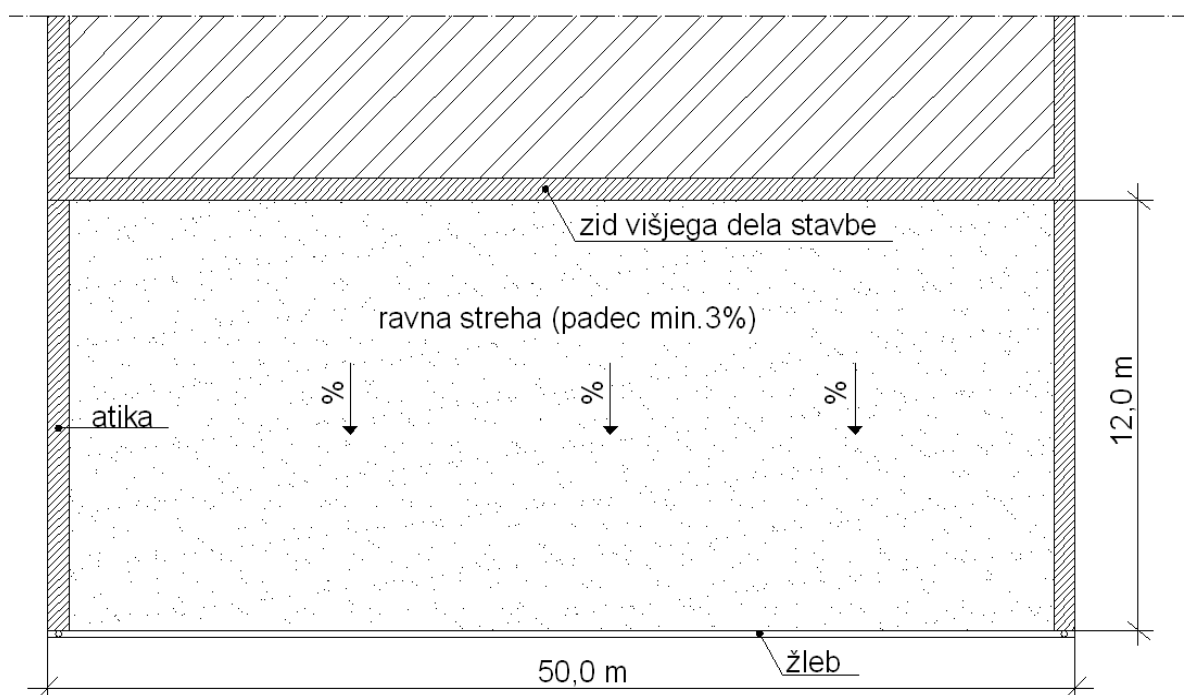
Detajl »ravna streha nad elementom iz lahkega betona
